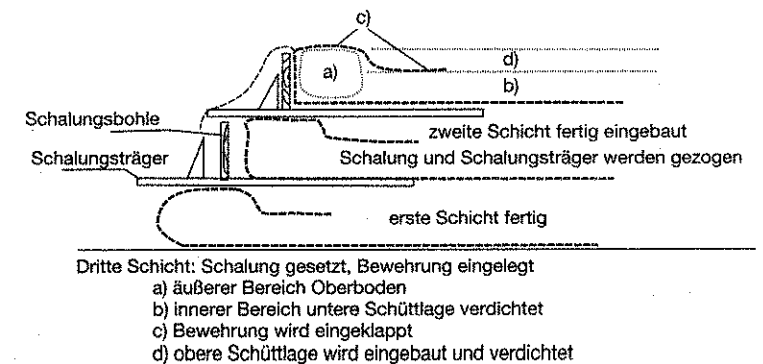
Aufbau einer bewehrten Böschung mit versetzbaren Schalungsträgern
